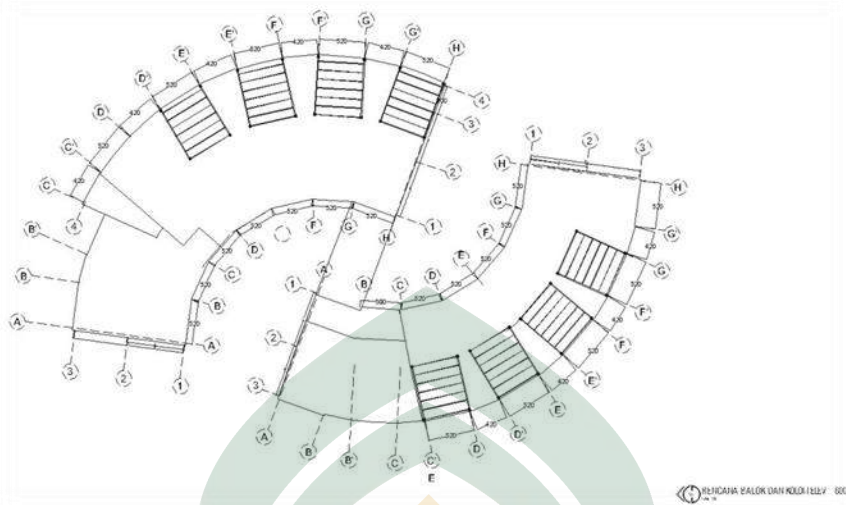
Rencana Kolom Dan Balok Lantai
